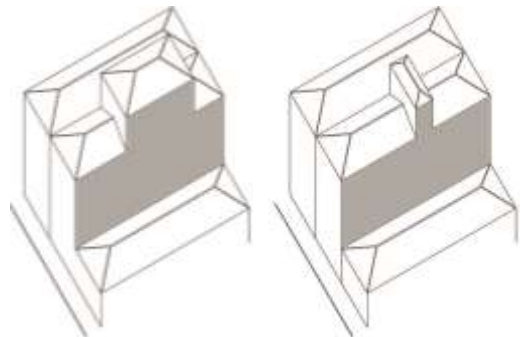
| Empena lateral com recorte comum e coroamento plano de água-mestra e piso suplementar recuado em relação às duas fachadas. (desenho do autor)
